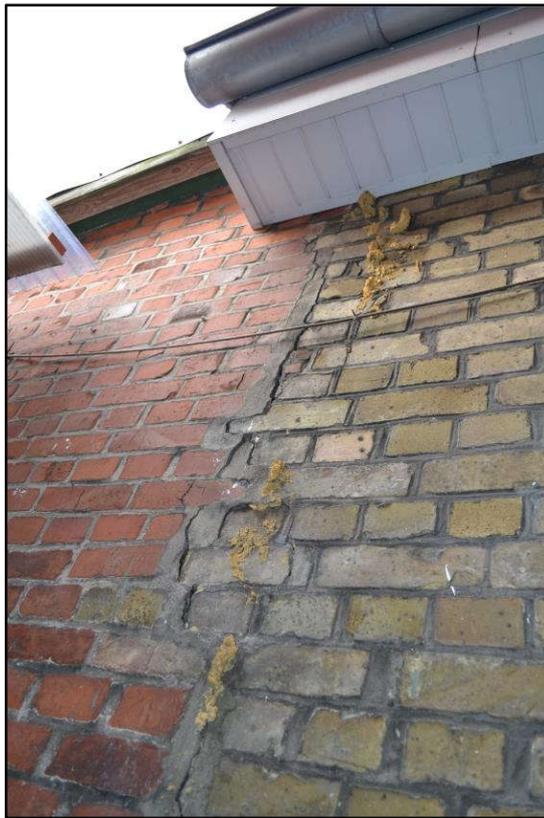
Rissbildung zwischen Wohnhaus und Waschküchenanbau (gem. Grundriss)
